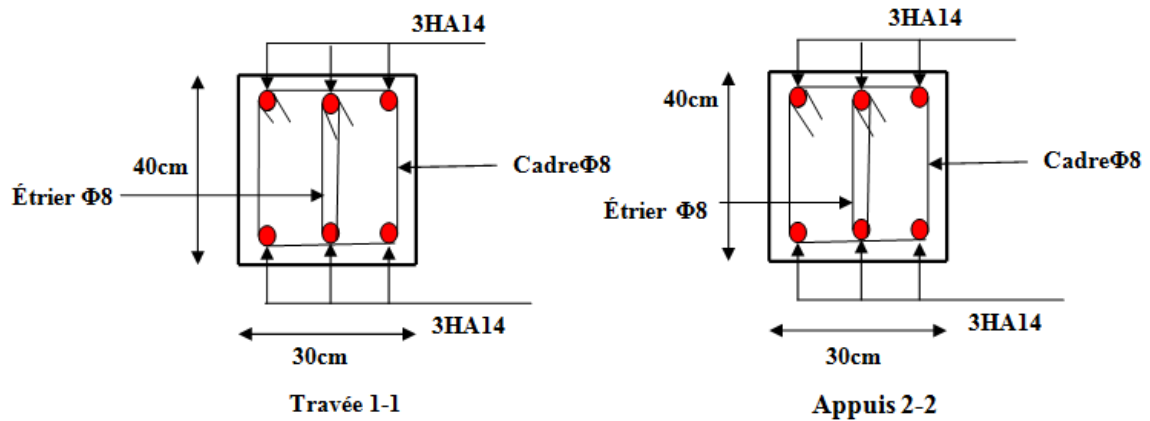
Schéma de ferrailage de la poutre secondaire de la terrasse
